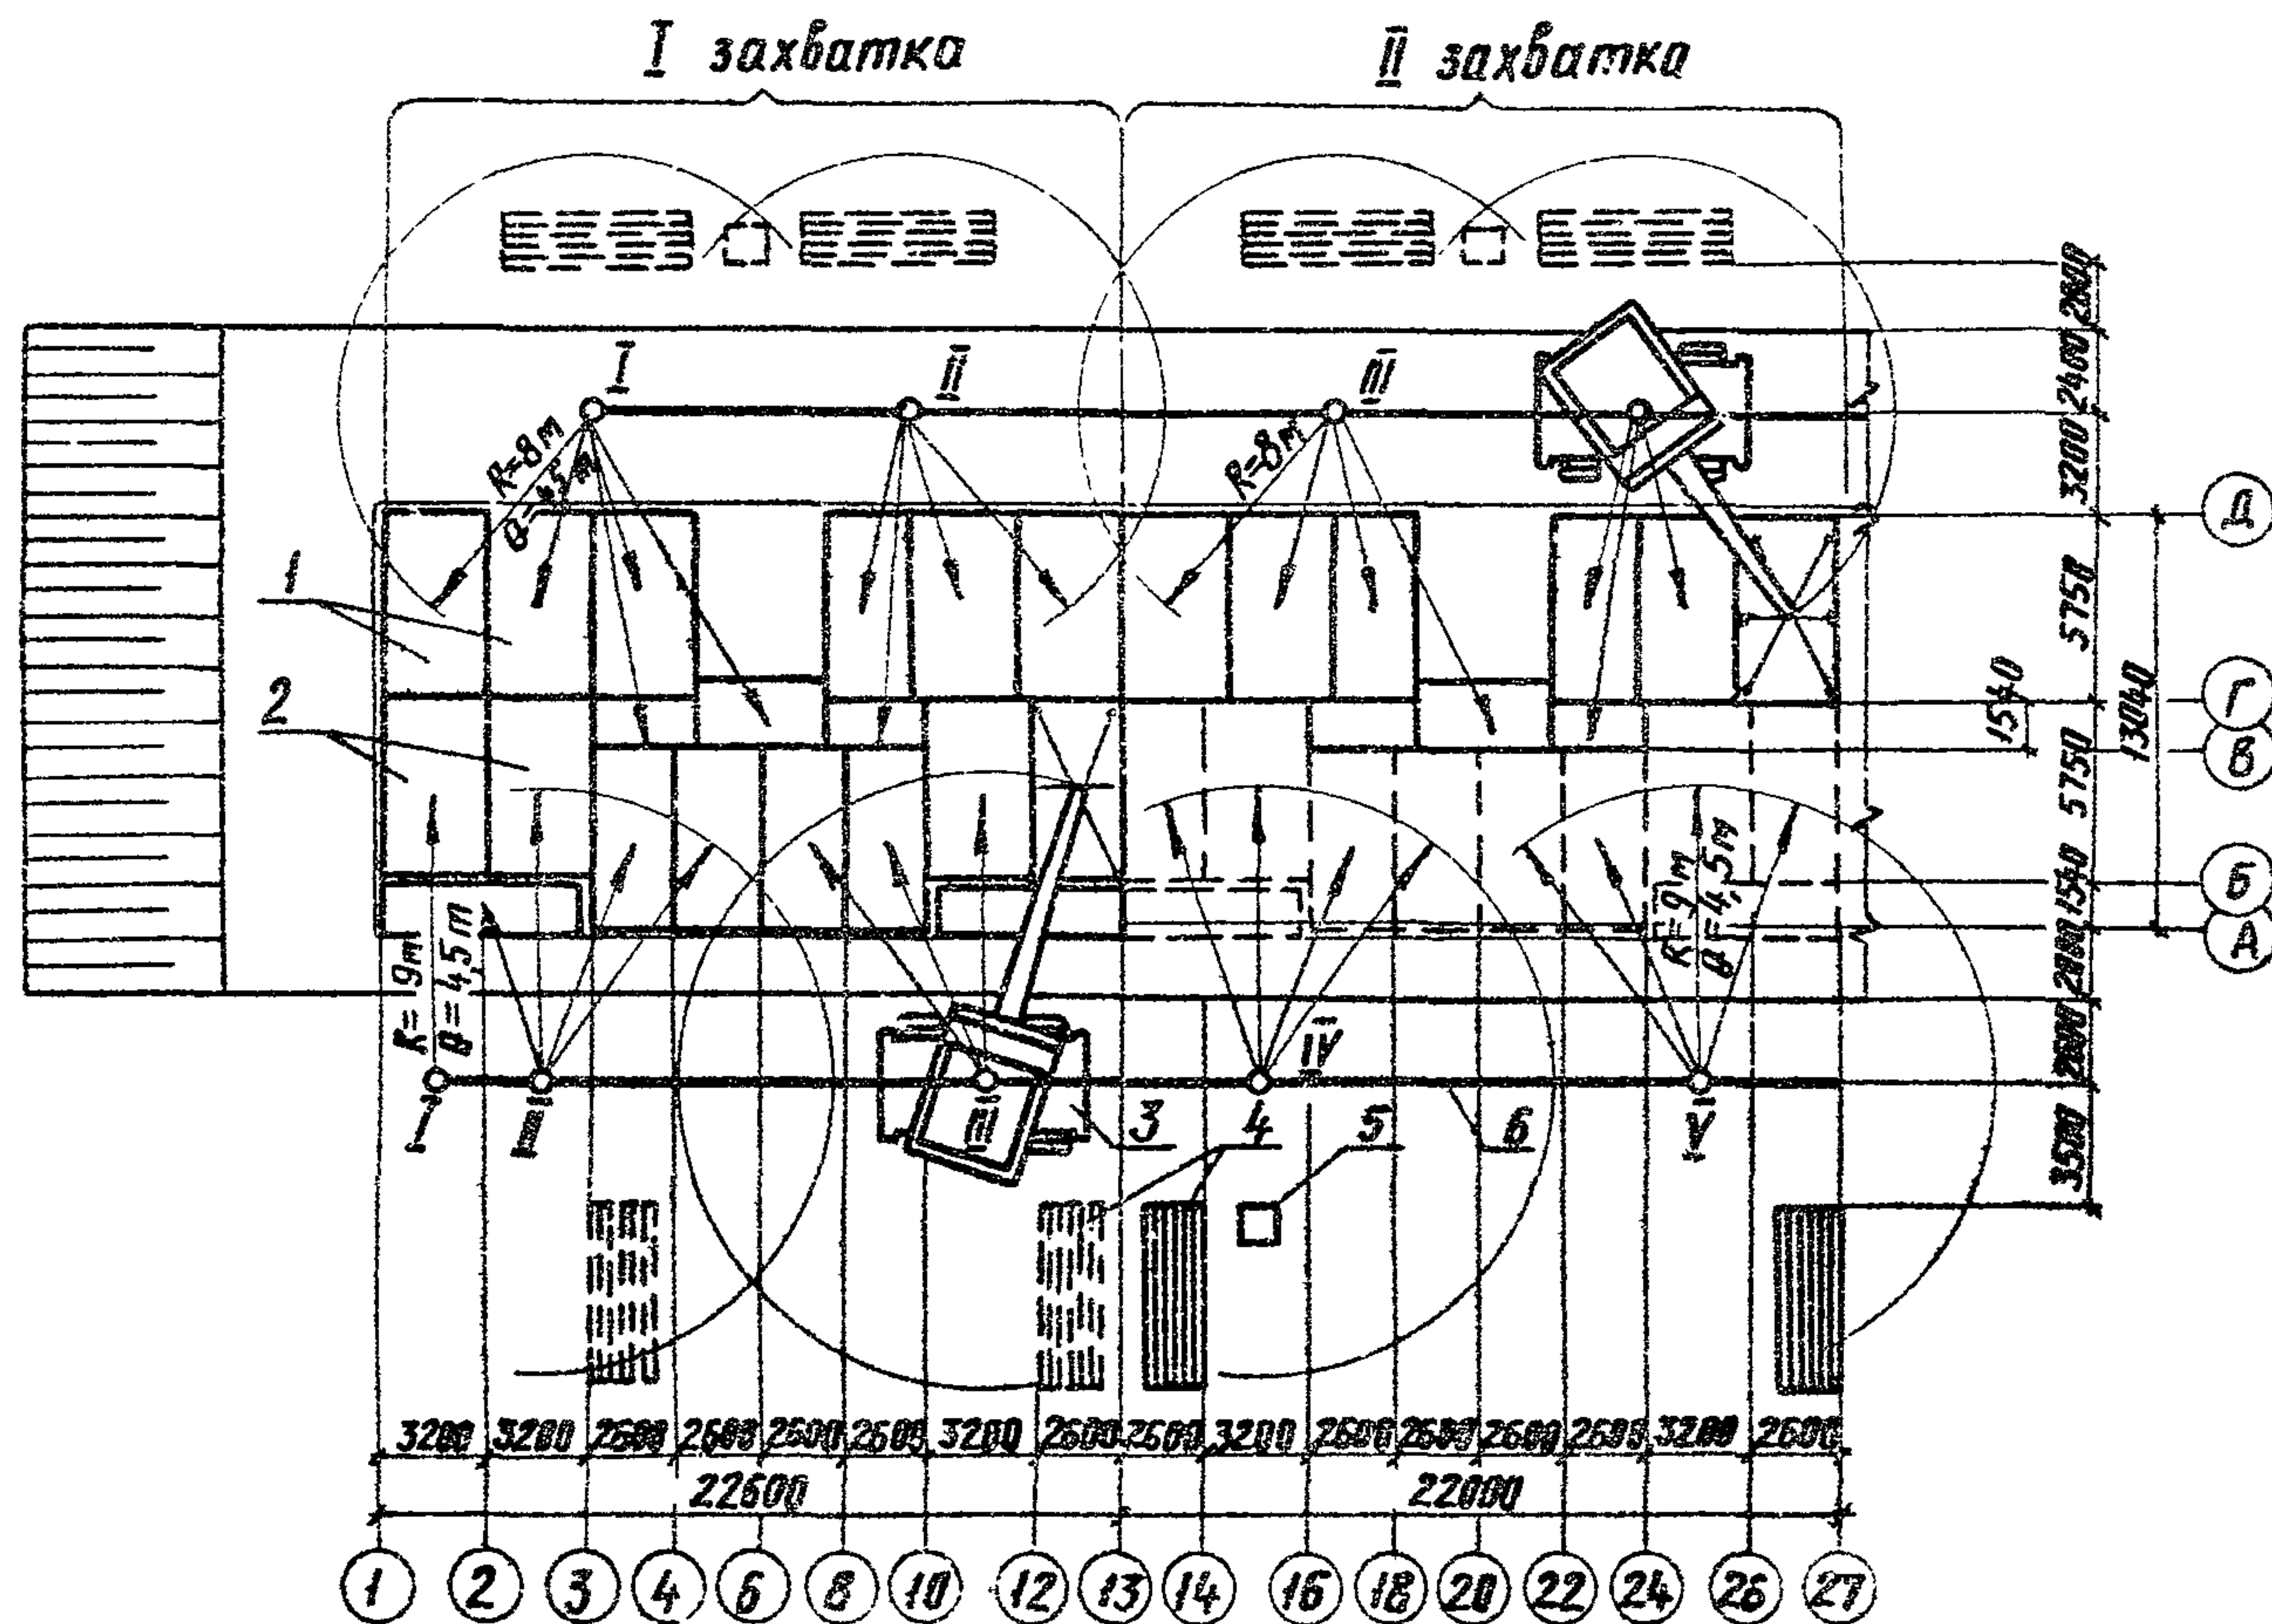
Схема организации работ по монтажу панелей перекрытия технического подполья: 1-панели смонтированные краном № 1; 2-панели смонтированные краном № 2; 3-пневмоколёсный кран К-161; 4-панели в кассетах; 5-ящик для раствора; 6-ось движения крана; I, II, III, IV, V-стойки крана
